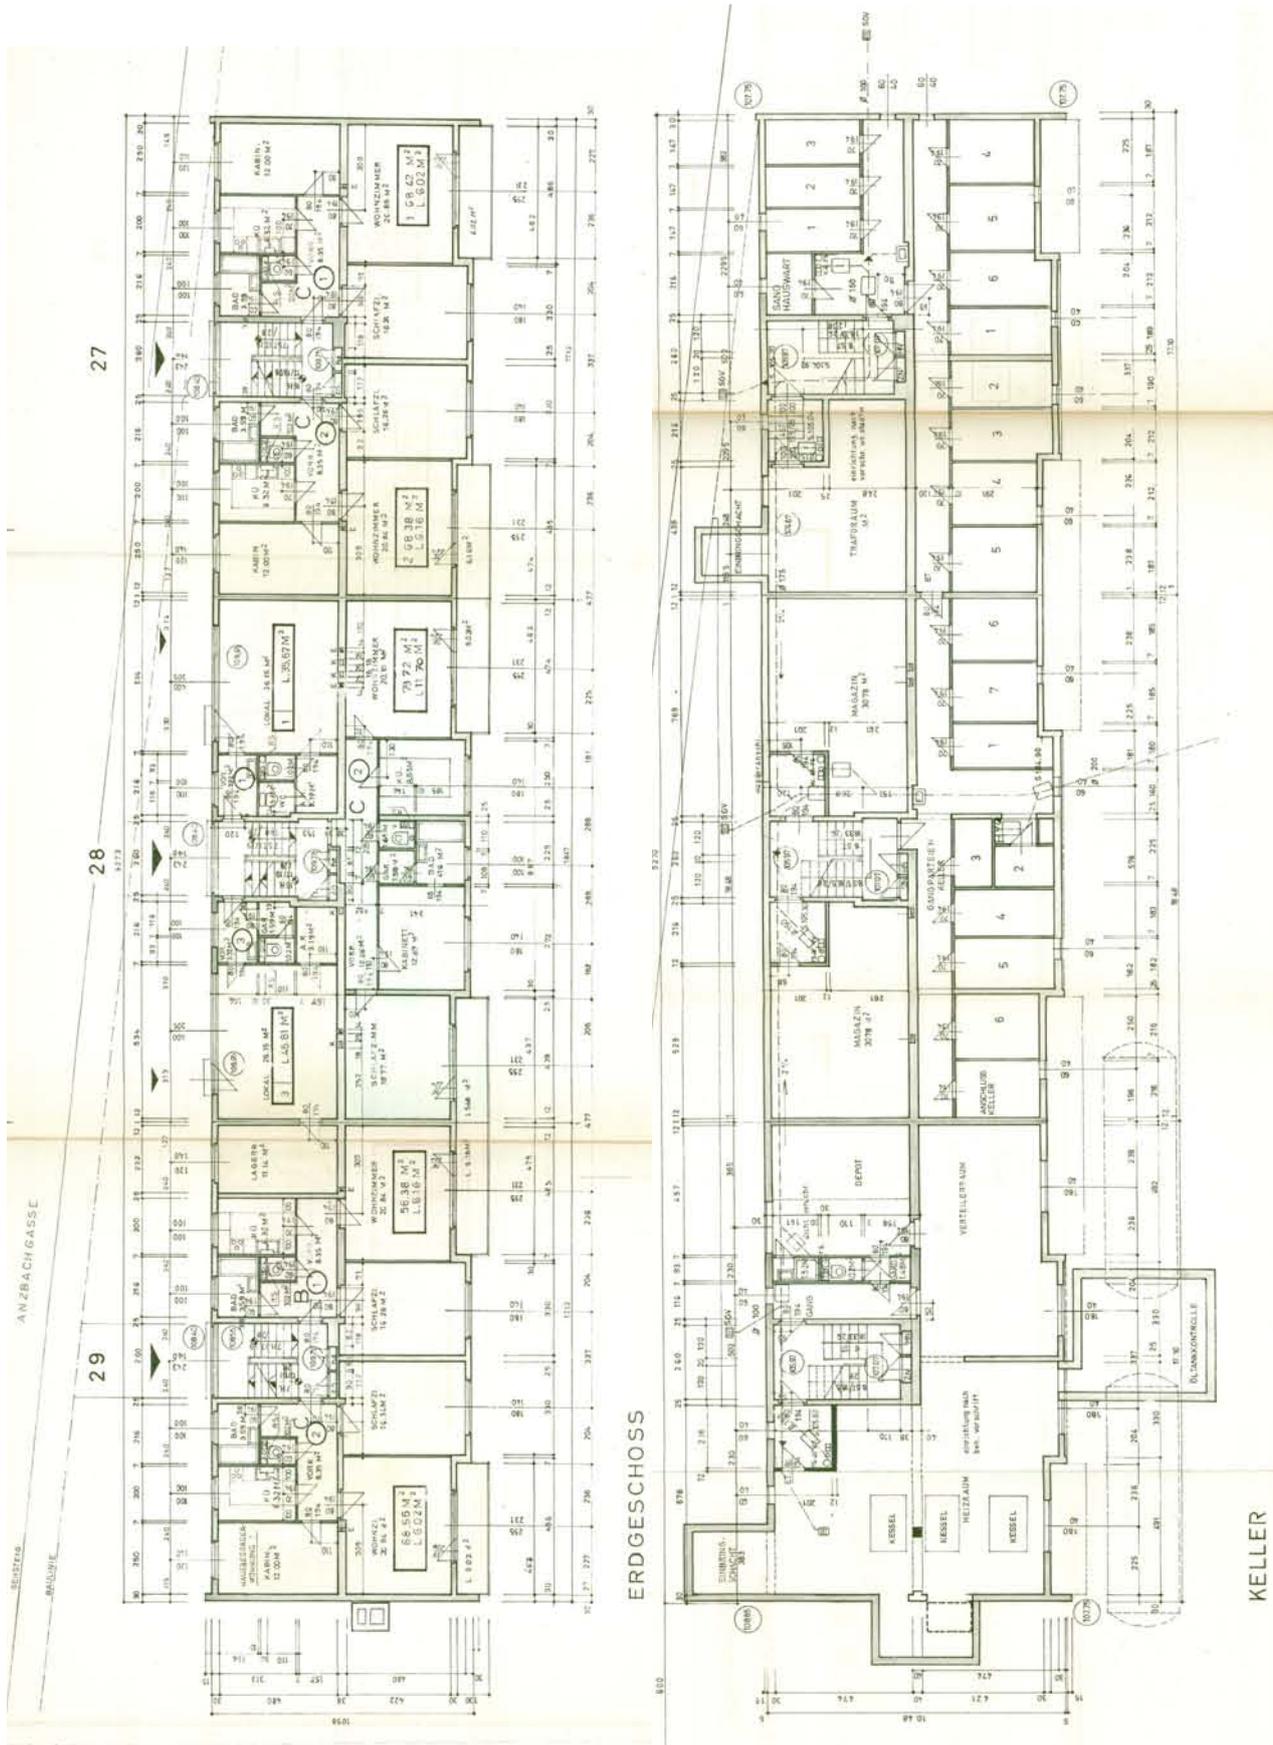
Grundriss des Kellers und des Erdgeschosses im bestehenden Gebäude [89]
